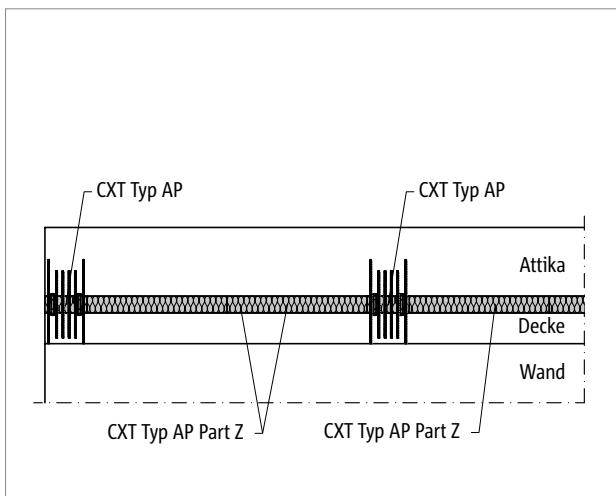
Schöck Isokorb® CXT Typ AP und CXT Typ AP Part Z: Attika
